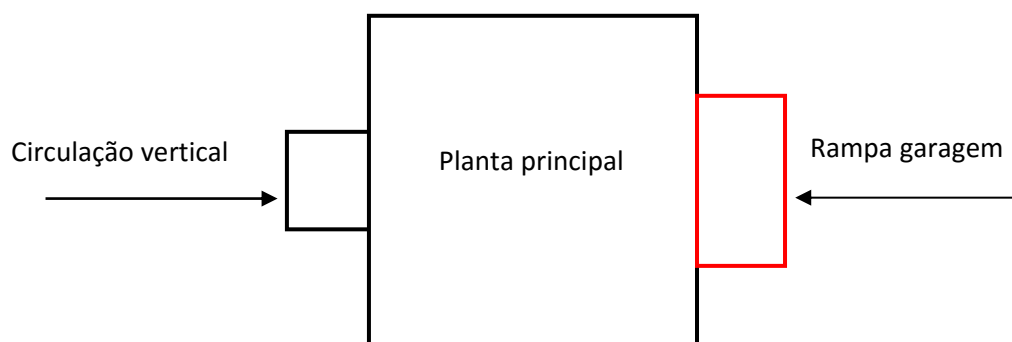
Esquema da edificação em planta. Fonte: Autor
